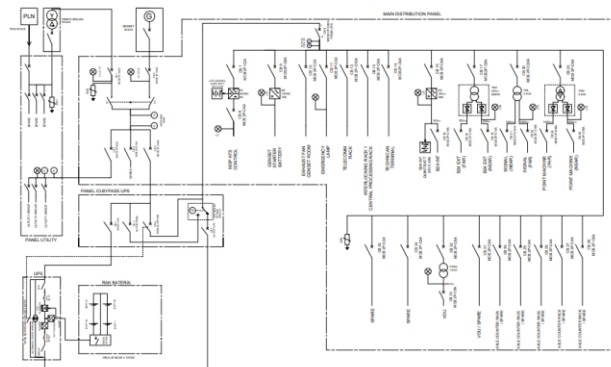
Desain Instalasi Listrik Gedung ER 2D
